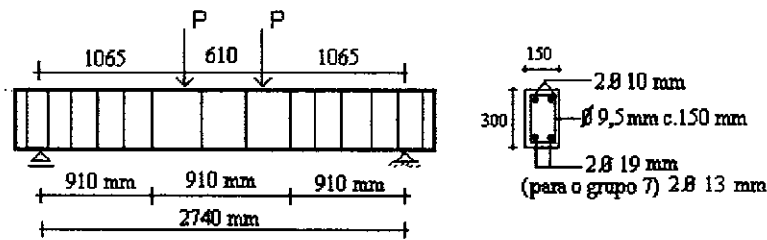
10 – Características geométricas e detalhamento das 14 vigas ensaiadas.
